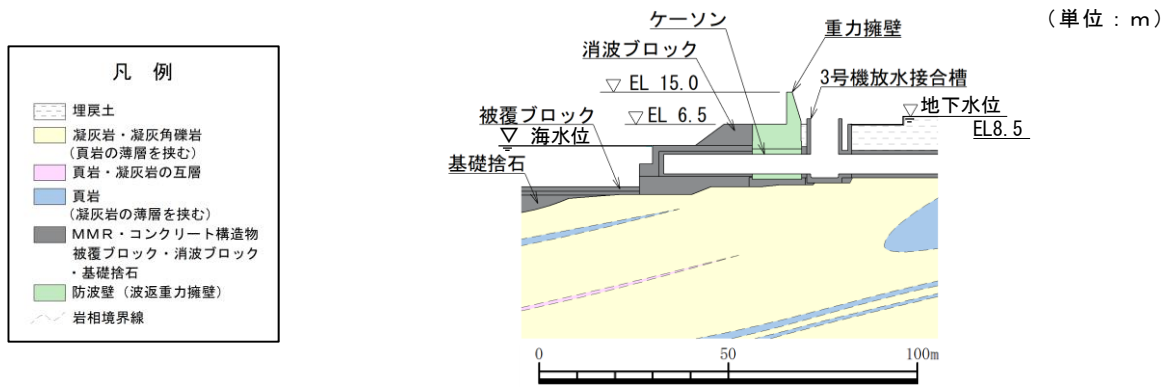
防波壁（波返重力擁壁）の横断面図（③-③断面）
